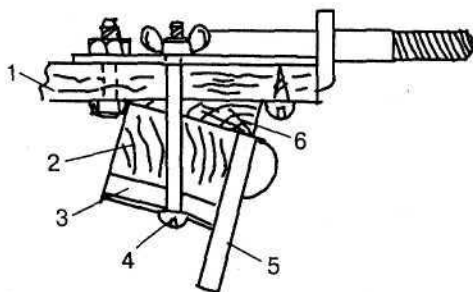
Установка поперечины на корпус: 1 — поперечина; 2 — стрингеры; 3 — накладка (фанера 8x55x100 мм); 4 — болт М6; 5 — борт; 6 — прокладка (дерево)
